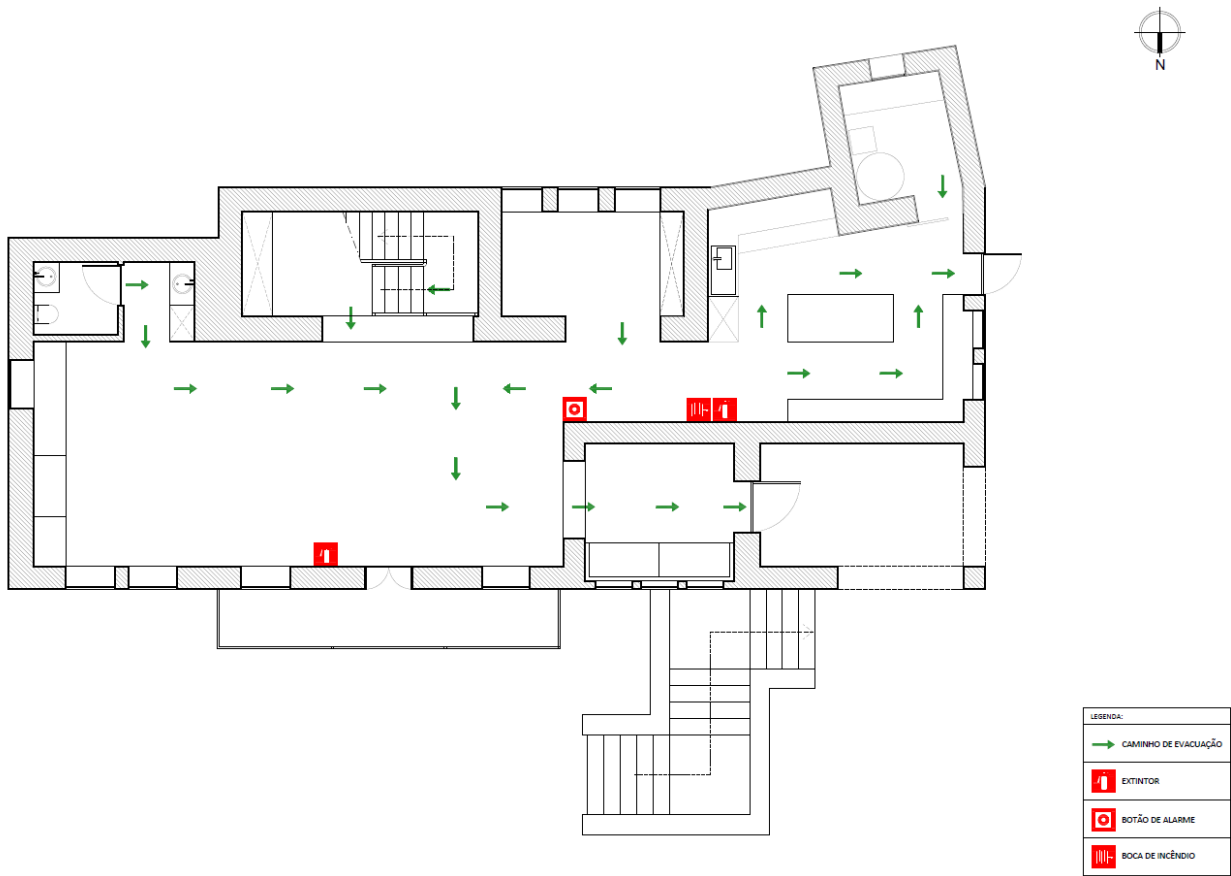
Planta de Incêndio, Alojamento Loureiro, Piso 0.
